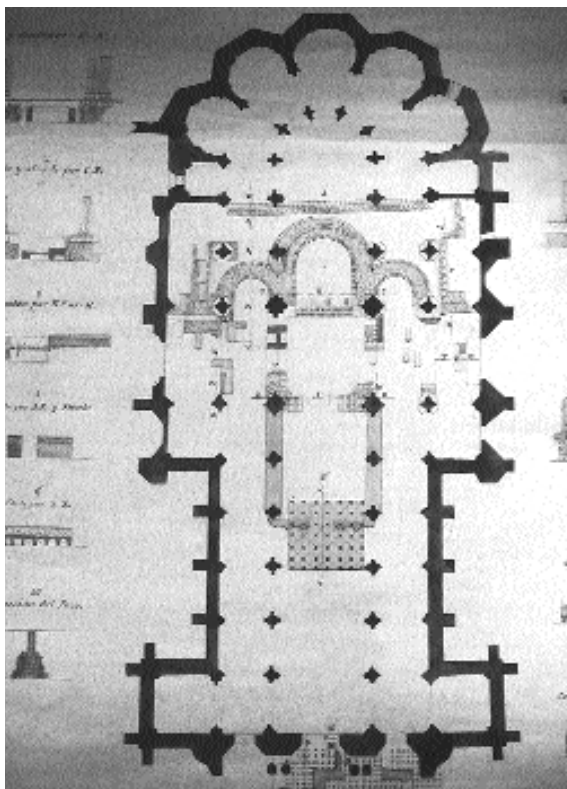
Planta de la catedral de León con la ubicación de las estructuras tardorrománicas excavadas por Demetrio de los Ríos.
